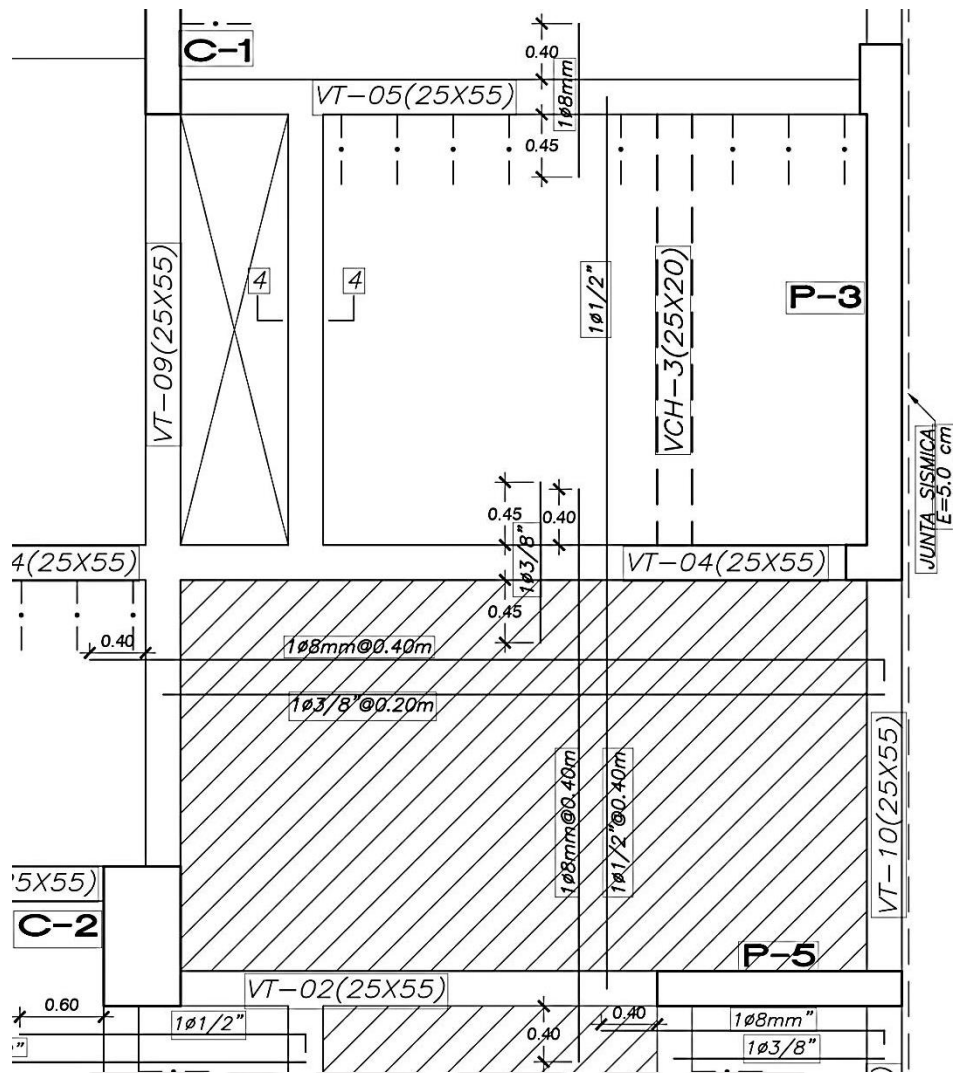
Refuerzo de la losa maciza y la losa aligerada para pisos típicos
